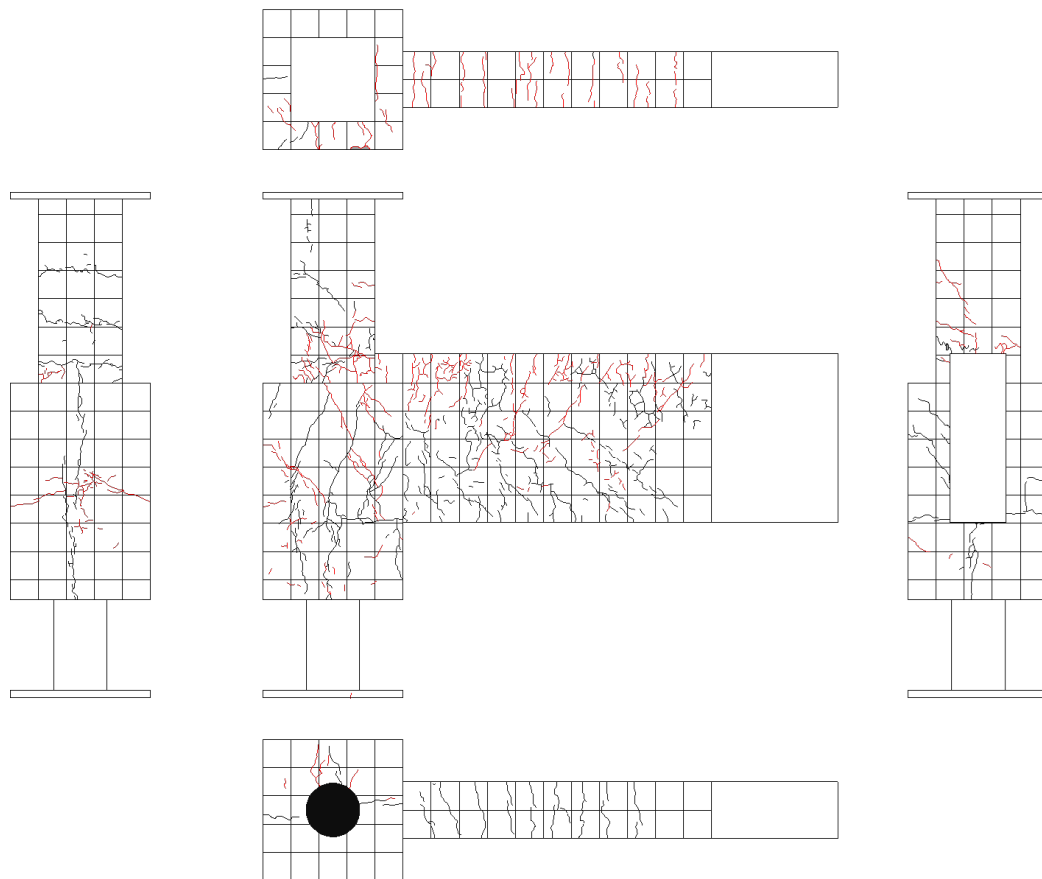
試験体 A-7b ひび割れ状況 (5Cycle)
